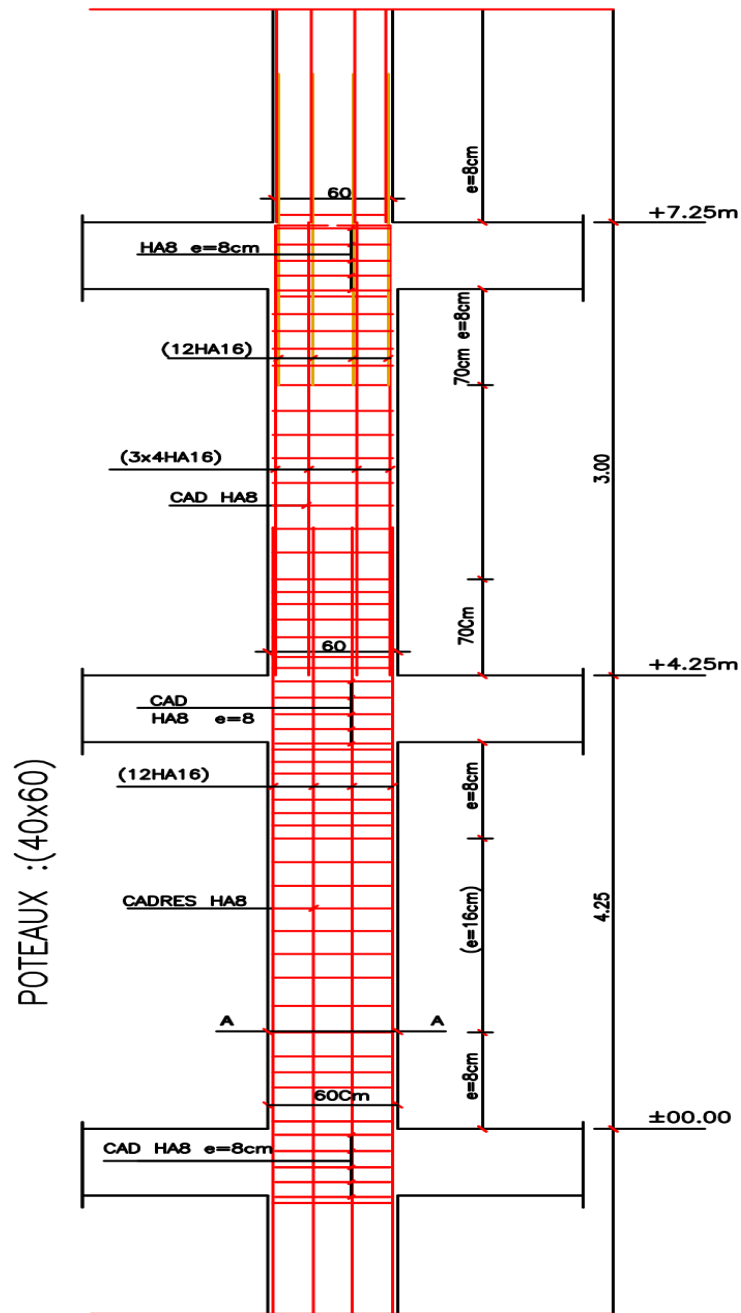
Ferrailage des poteaux 60×40 cm²
